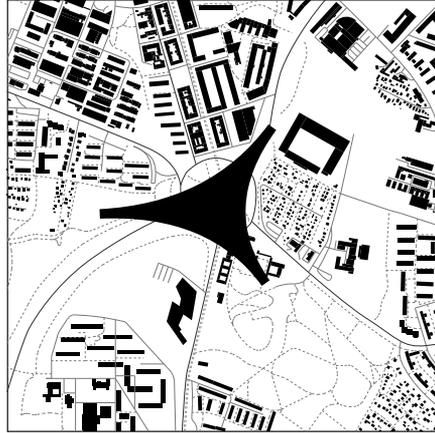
Auto Stadt Plus - Lageplan von Berliner Stadtteilen, Quelle: ED
